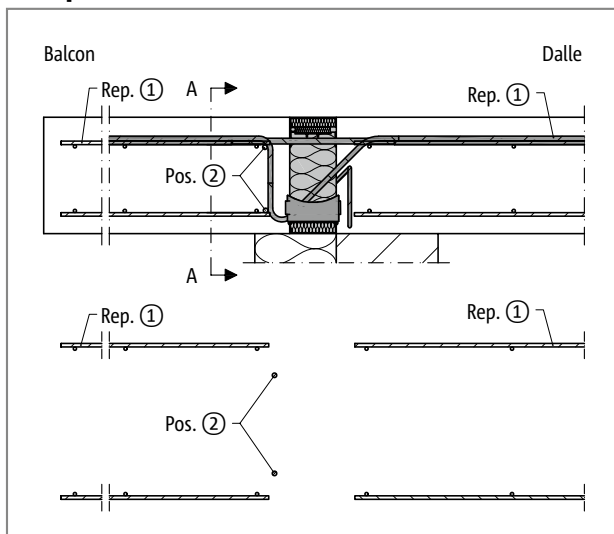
Schöck Isokorb® T Type K-E, K-T : Renforcement sur site ; bord de plancher avec supports muraux
